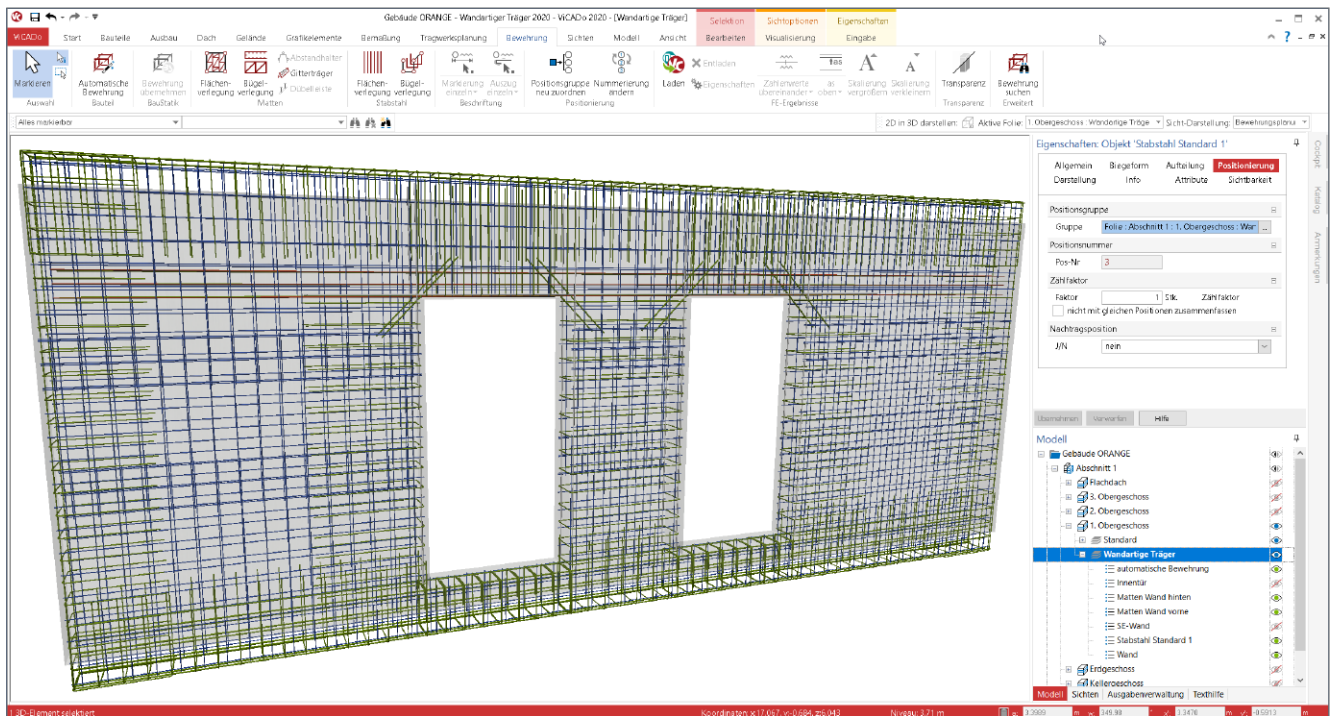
3D-Bewehrung im Bauteil „Wandartige Träger mit Öffnungen“
